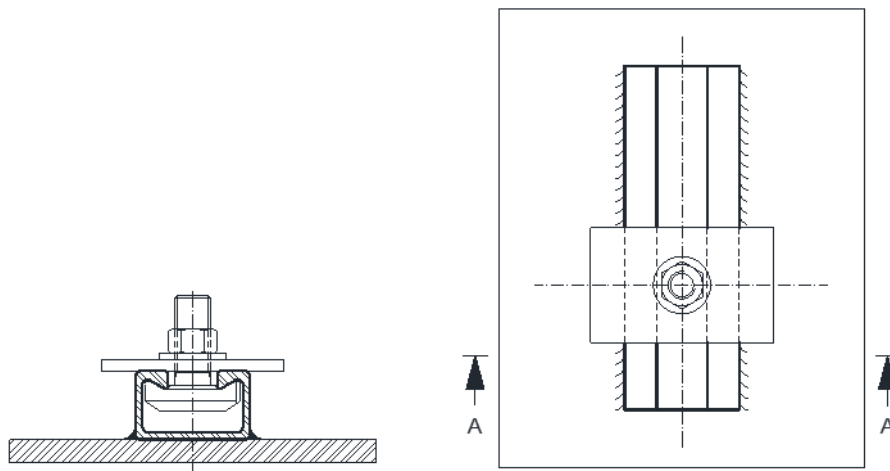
Bsp. einer warmgewalzten Montageschiene mit entsprechenden Spezialschrauben
